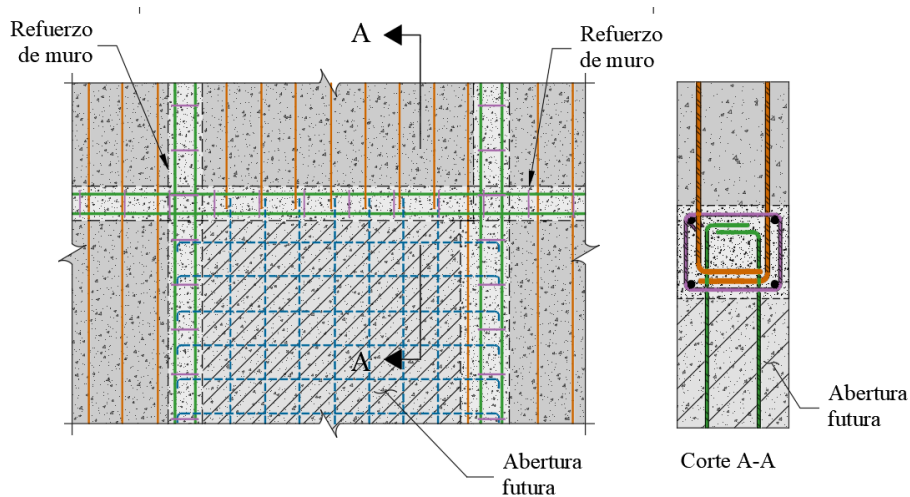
b - Anclaje del acero de refuerzo del muro en las aberturas futuras
